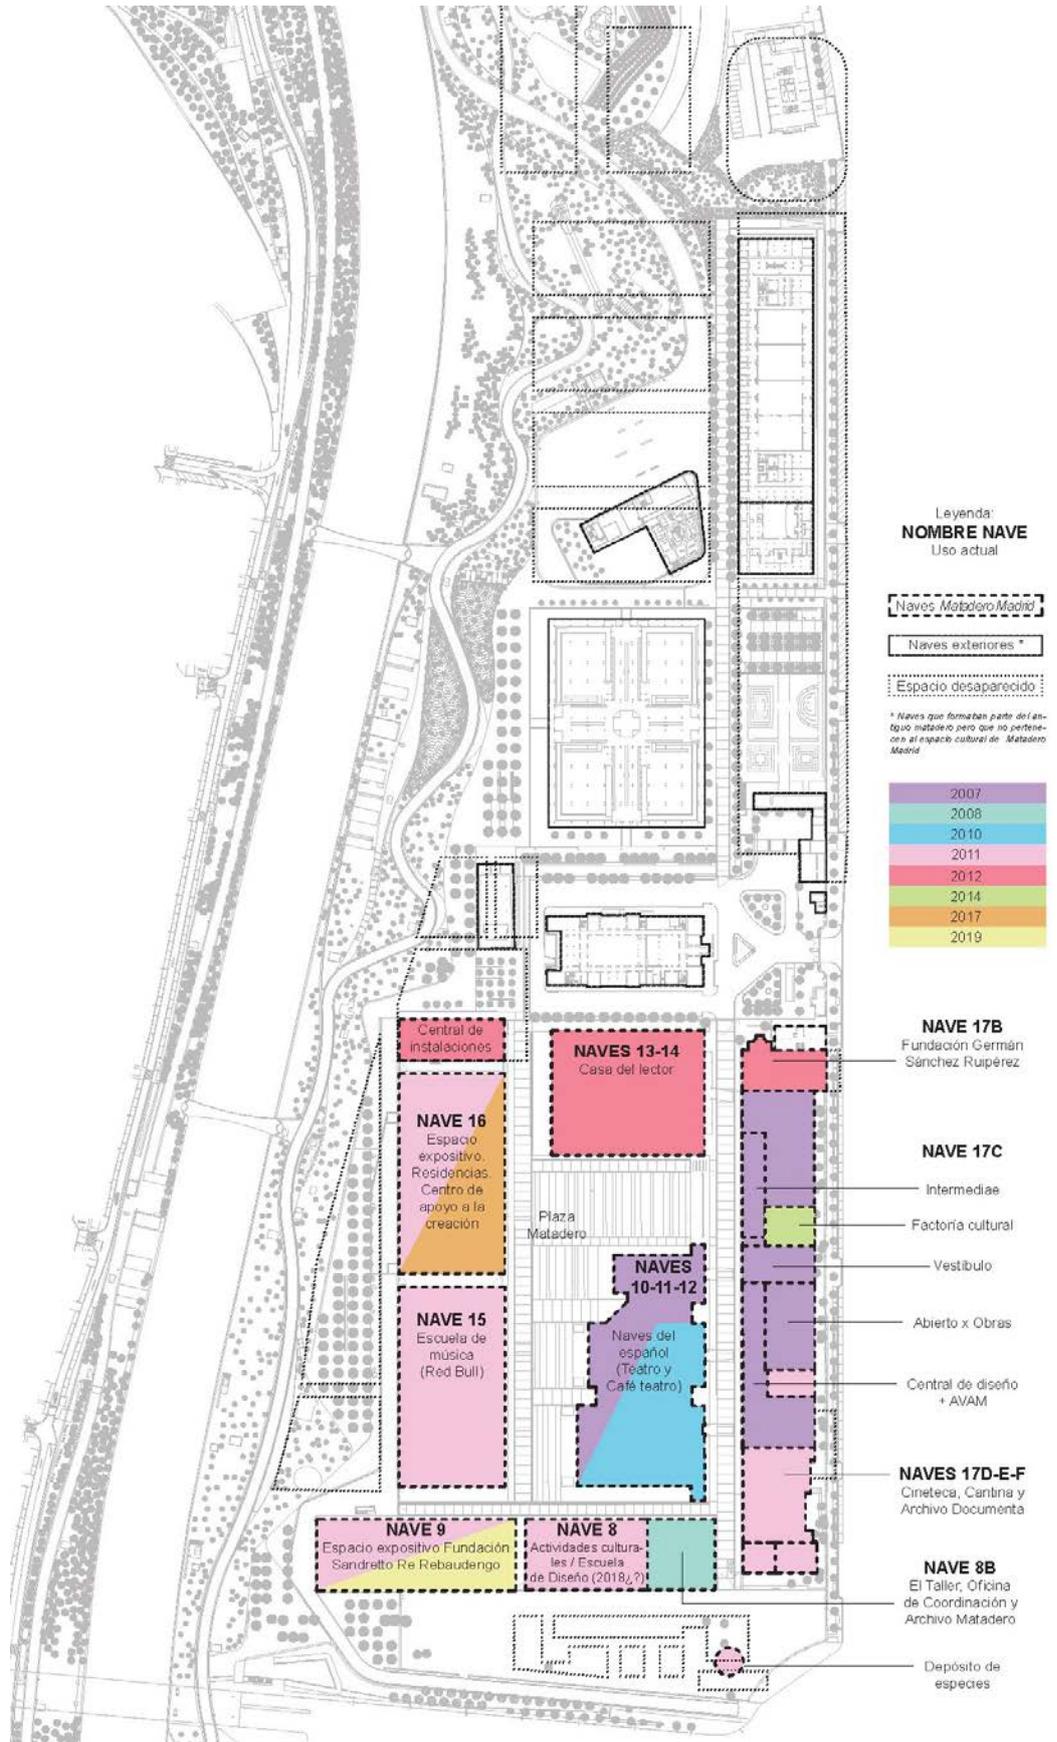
Plano cronológico de las intervenciones arquitectónicas y nuevos usos en *Matadero Madrid* (Fuente: plano realizado por la autora sobre planimetría original de los arquitectos Burgos&Garrido, Porras La Casta, Rubio Álvarez-Sala y West 8).
